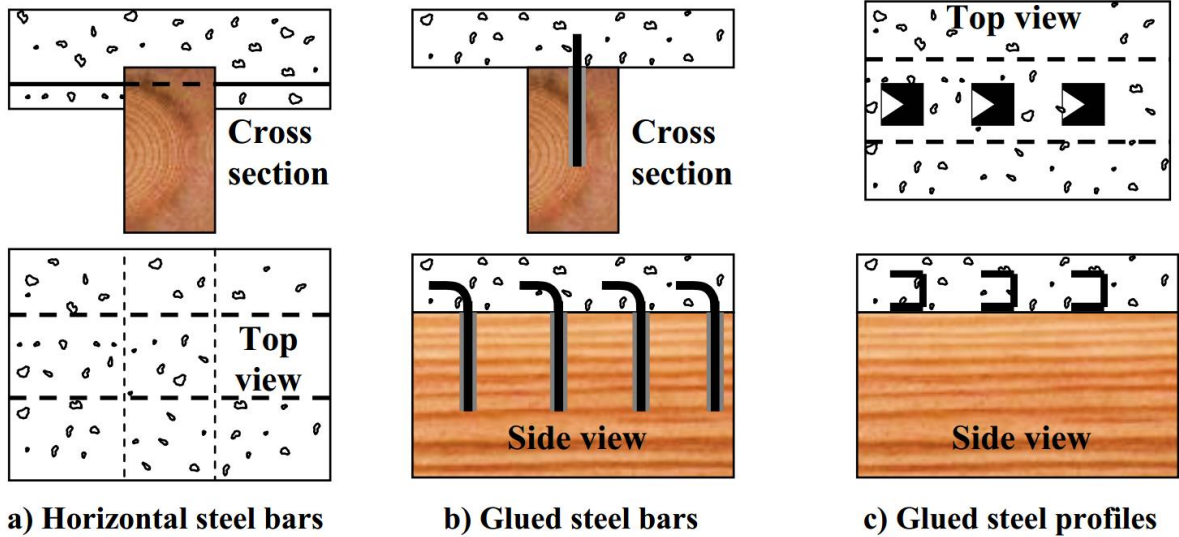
Barres horizontales en acier, barres en acier collées et profilés en acier collés aux poutres en bois. [13]
